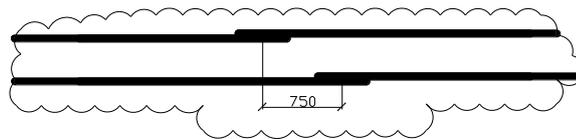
Схема нахлёста горизонтальной арматуры стен
